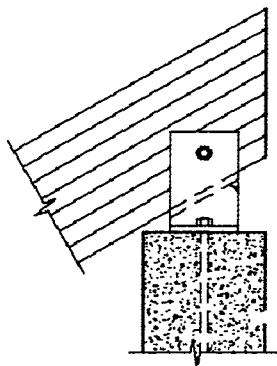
斜木梁与混凝土基础或砖基础连接上部节点示意
